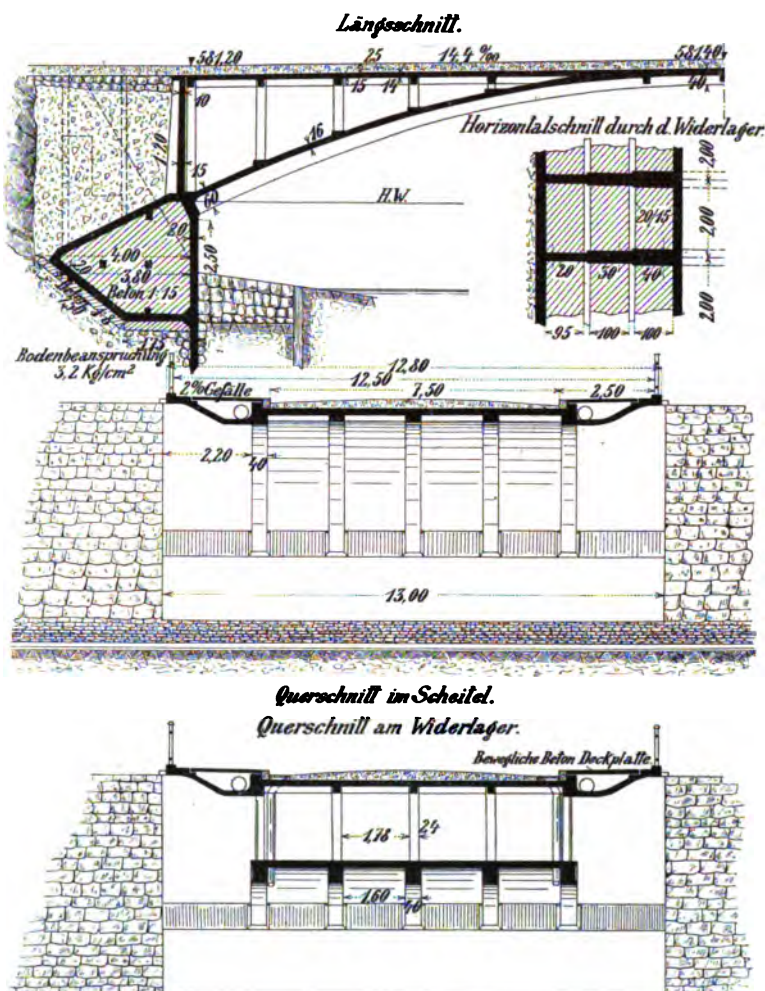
Längs- und Querschnitte der Sillbrücke.
